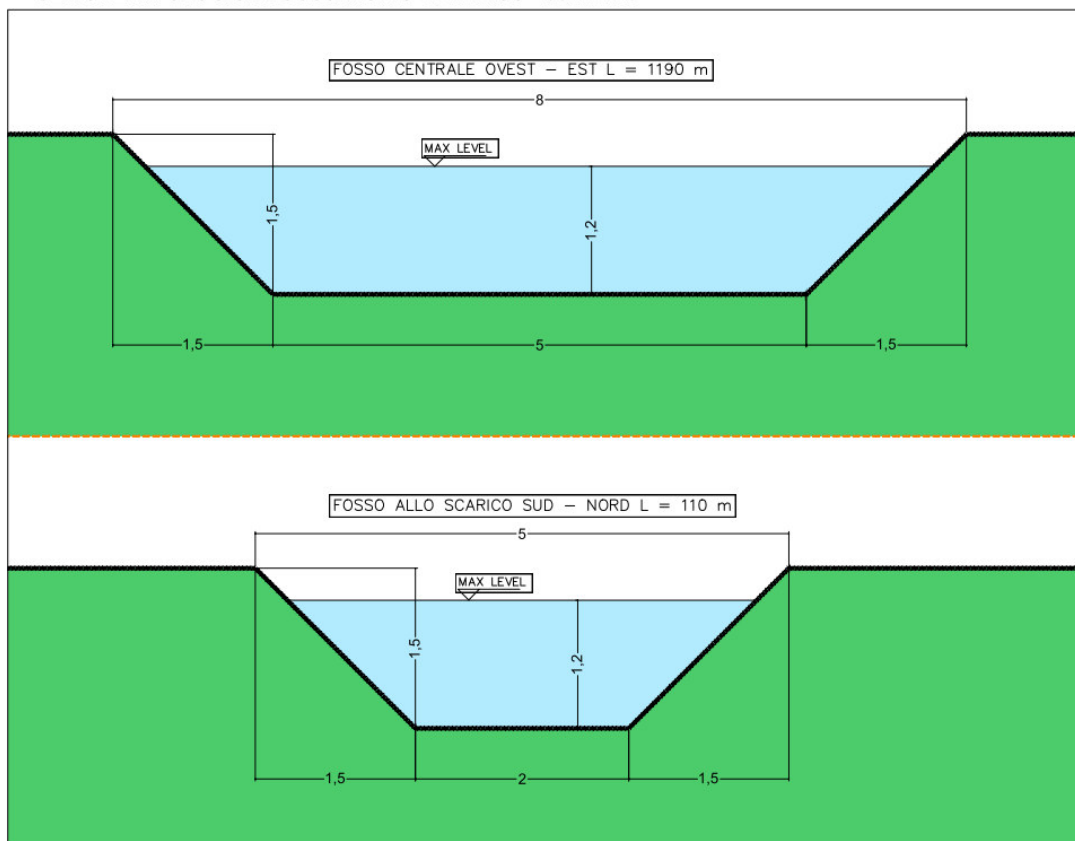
Sezione del fossato centrale e scolina a nord – stato di progetto
